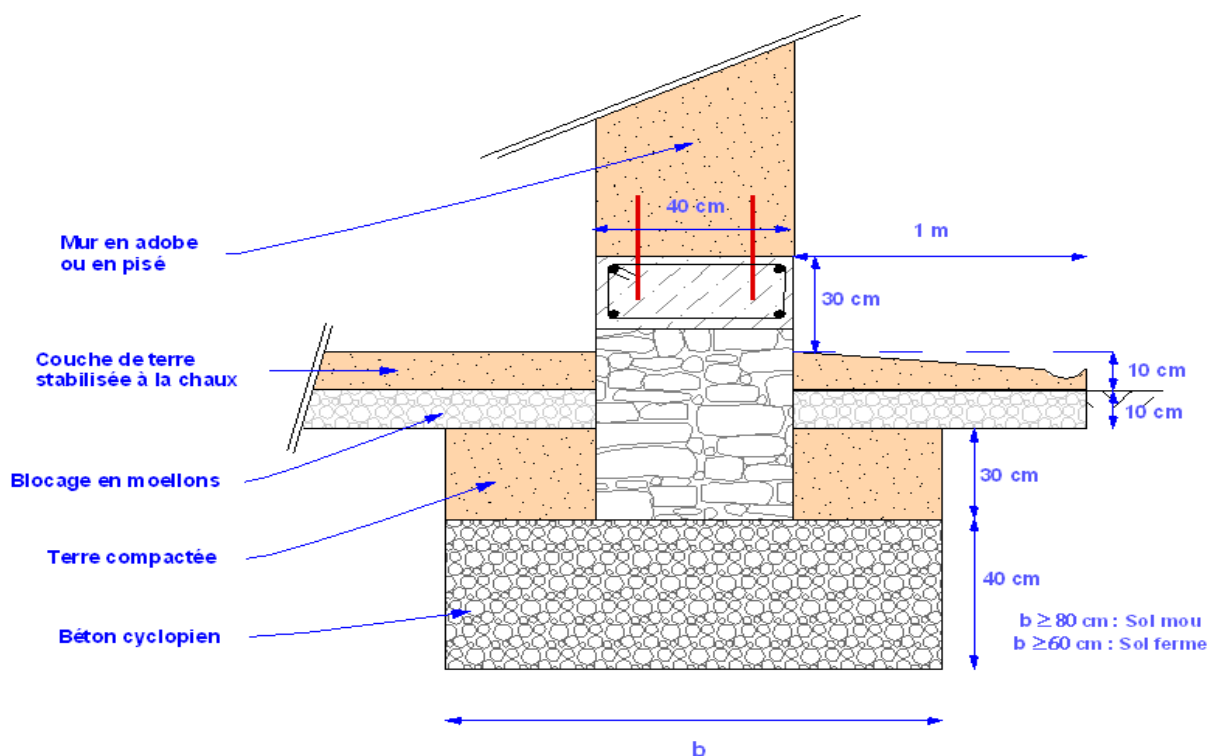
Fondation en béton cyclopéen + Chaînage en BA + Tiges d'attaches mur Chaînage
